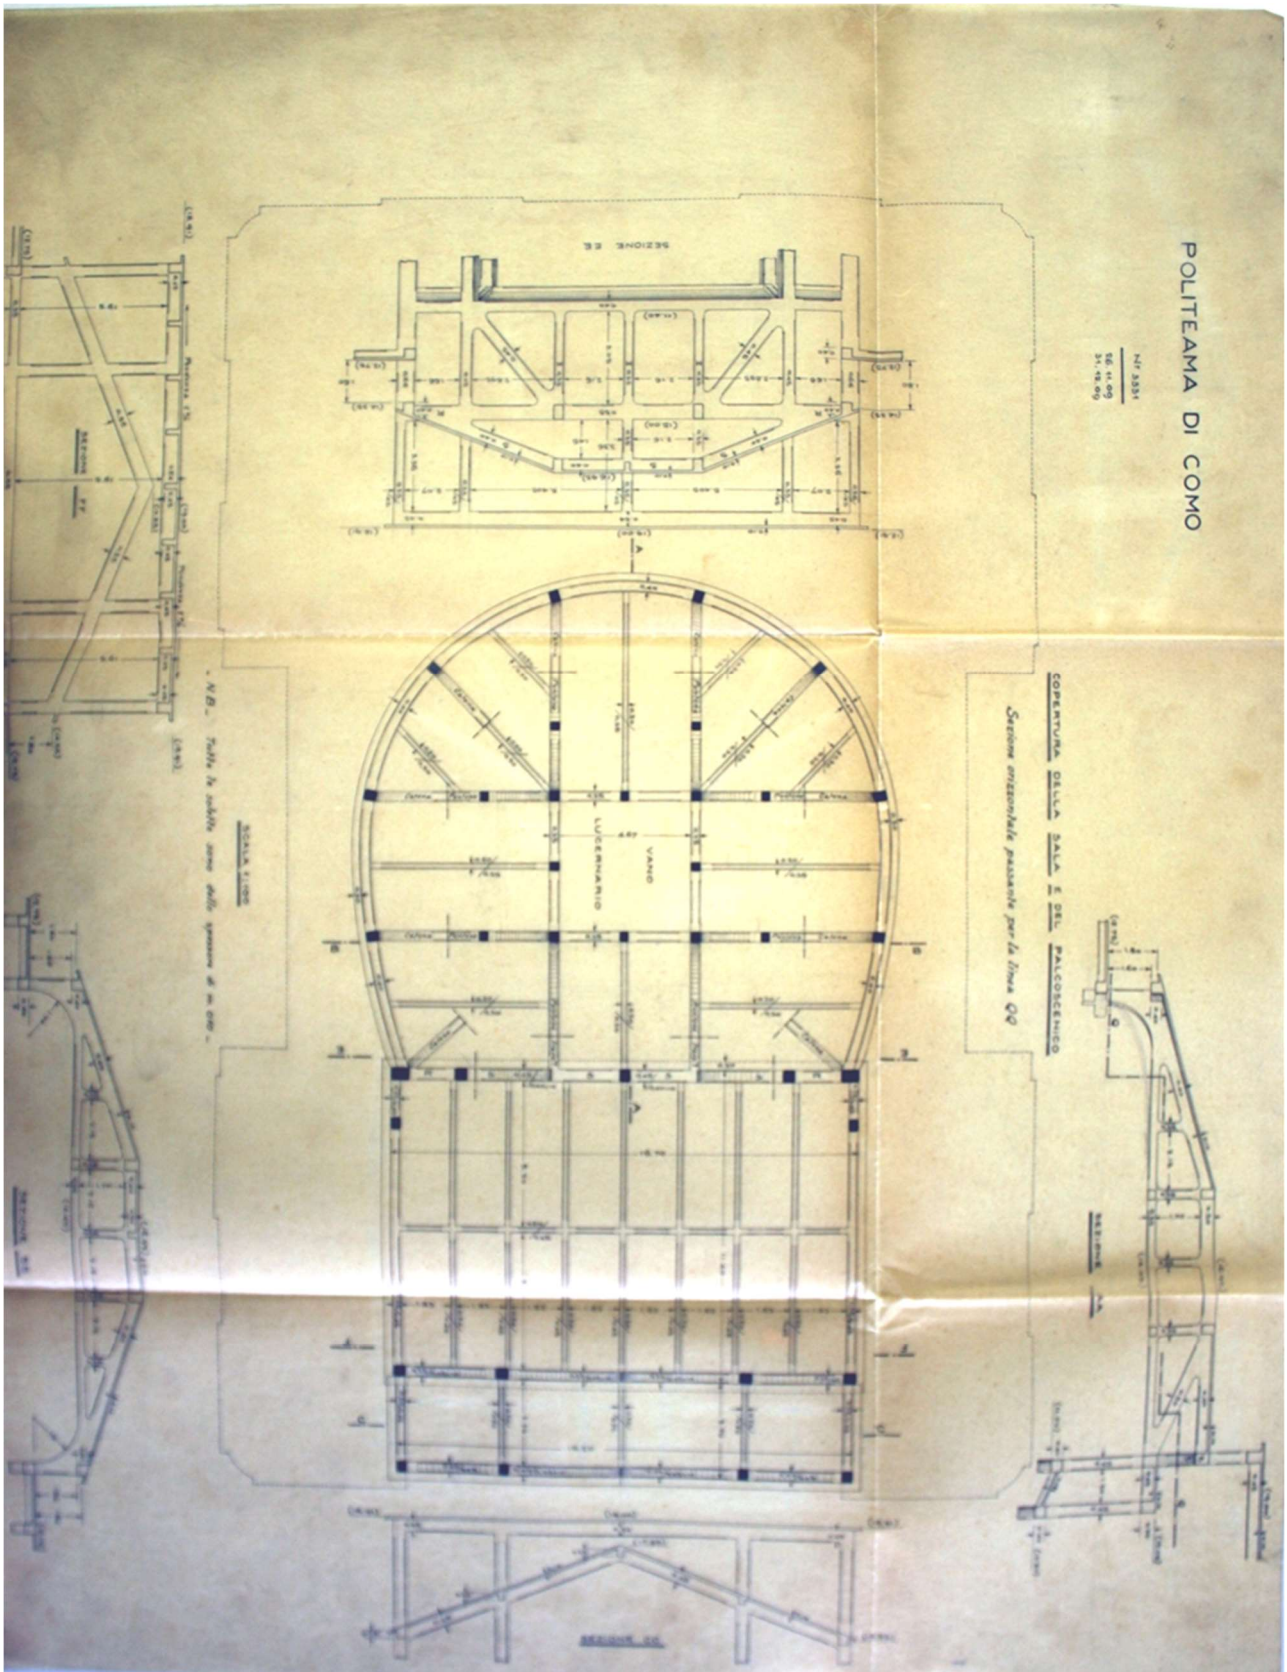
Pianta pilastri e puntoni lucernario, solaio copertura torre scenica
